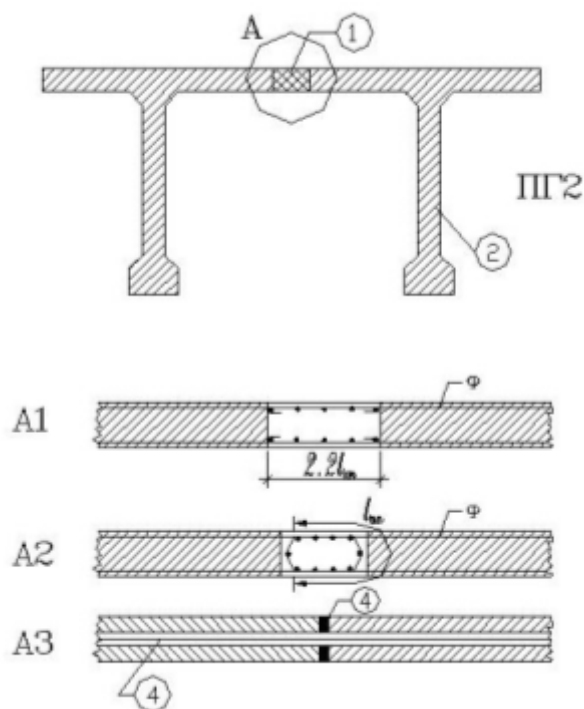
Сглобяеми конструкции от П-елементи; (1) замонолитващ бетон; (2) монтажни елементи
